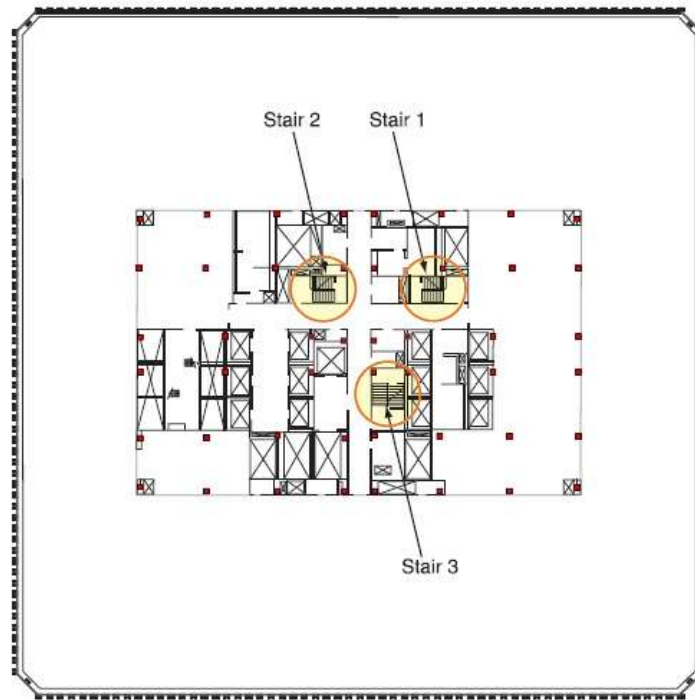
Planimetria che mostra la collocazione delle scale di emergenza
